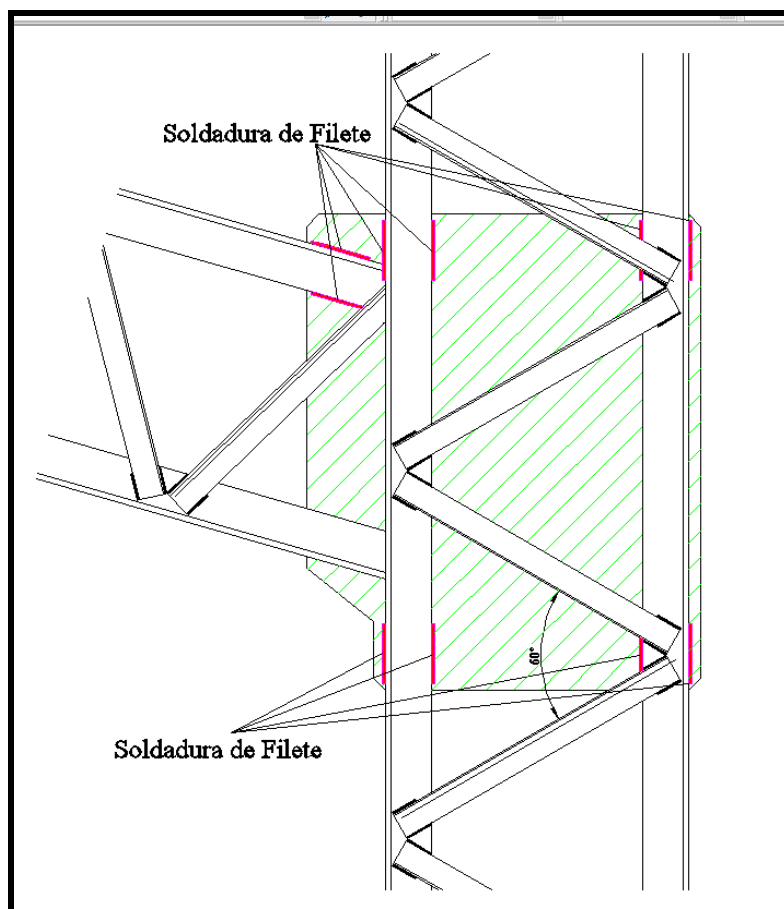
Detalle de soldaduras de filete en placa de unión.
